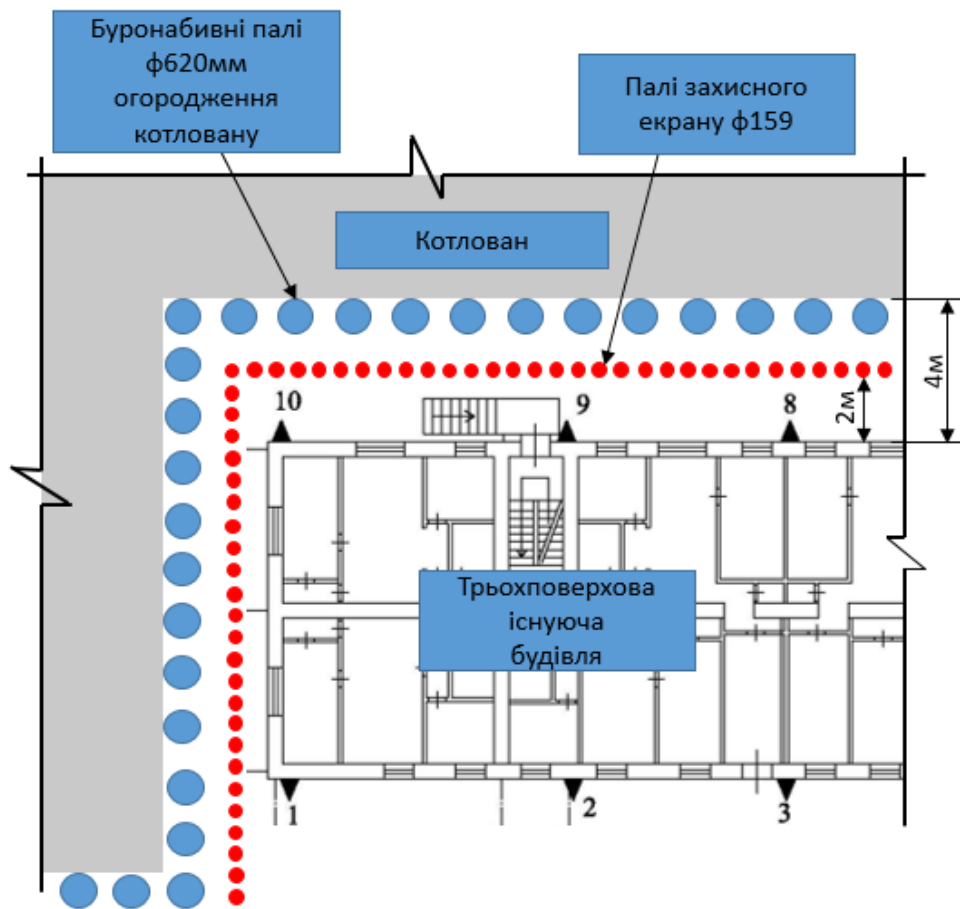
Схема влаштування осадочних марок на існуючій будівлі.
